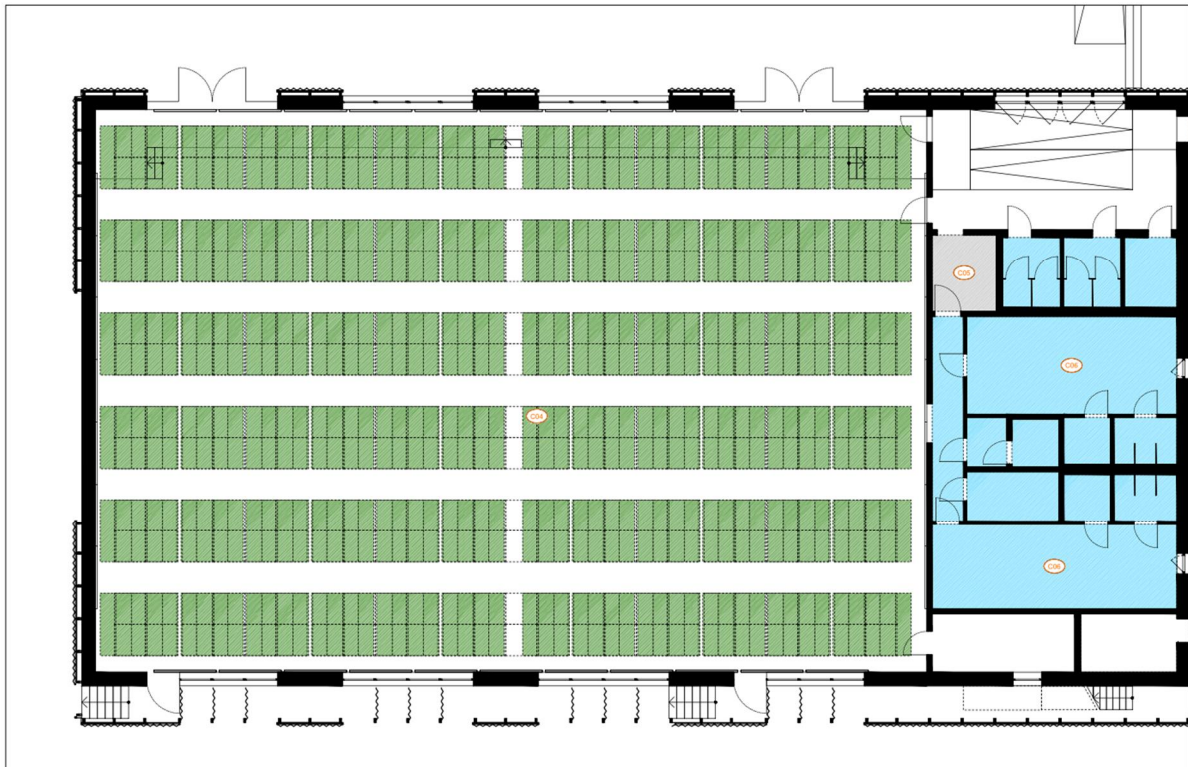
Planimetria del soffitto della palestra con indicata in verde la posizione dei pannelli fonoassorbenti a soffitto C04 (materassino in lana di roccia spess. 40mm)
